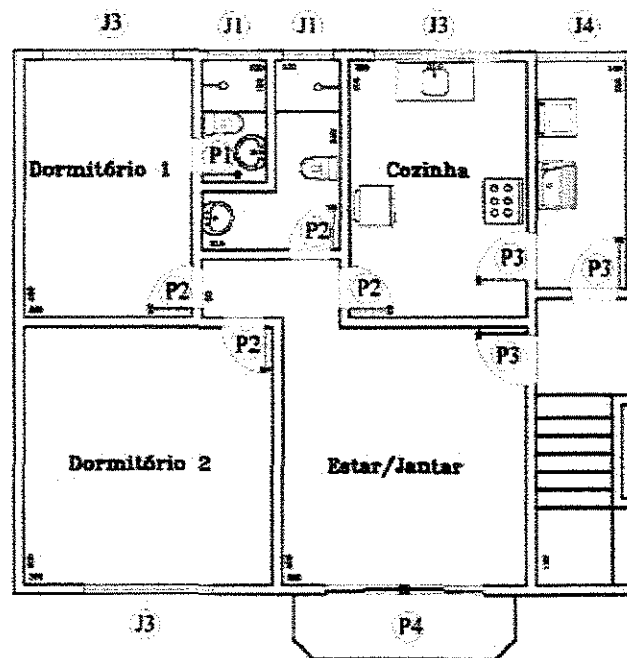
Planta baixa do apartamento do edifício 2.
